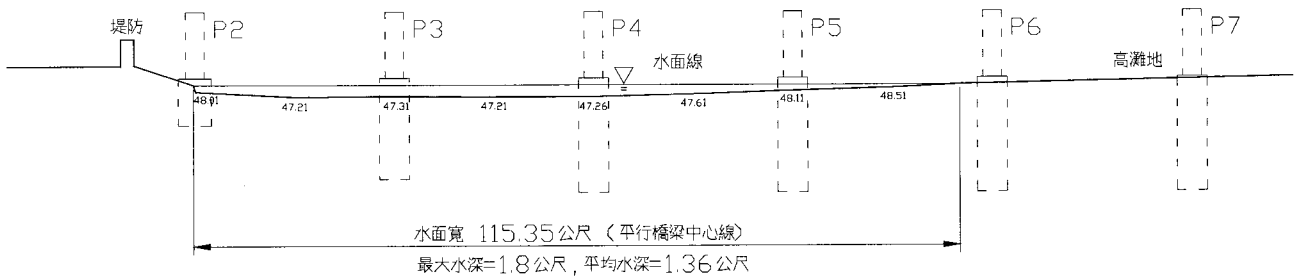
橋梁中心線上游 25 公尺河床斷面圖 (水平 : 垂直=1 : 1)
